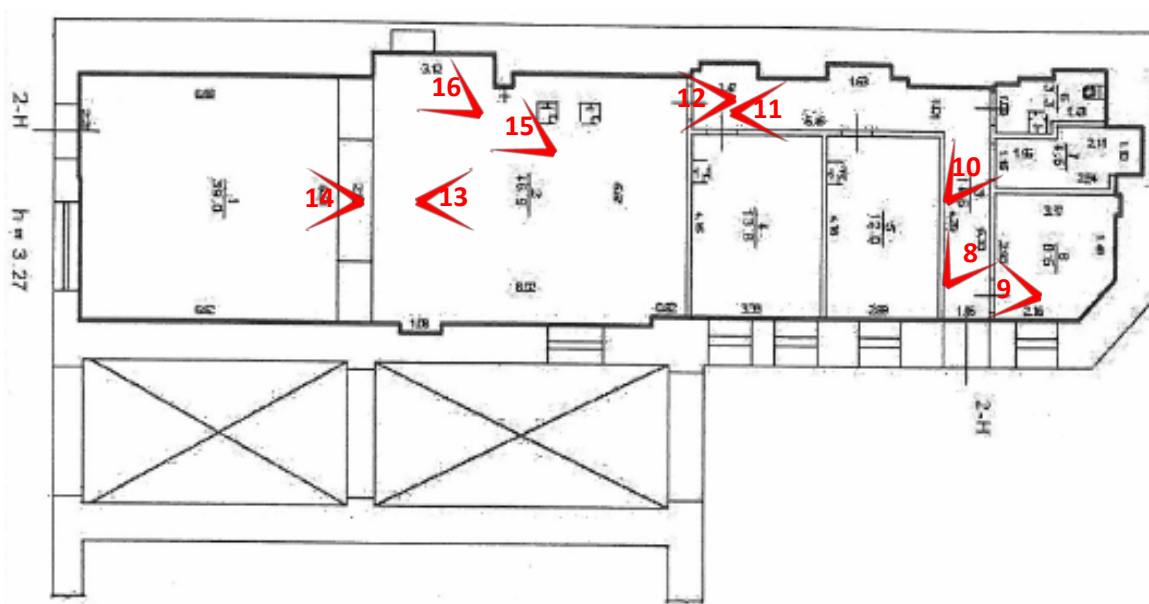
Схема фотофиксации на фрагменте плана 1 этажа
